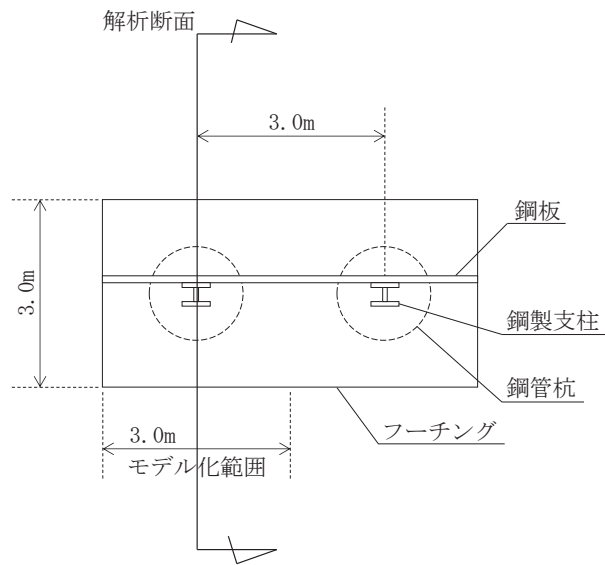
断面奥行き方向のモデル化概要 (平面図)
